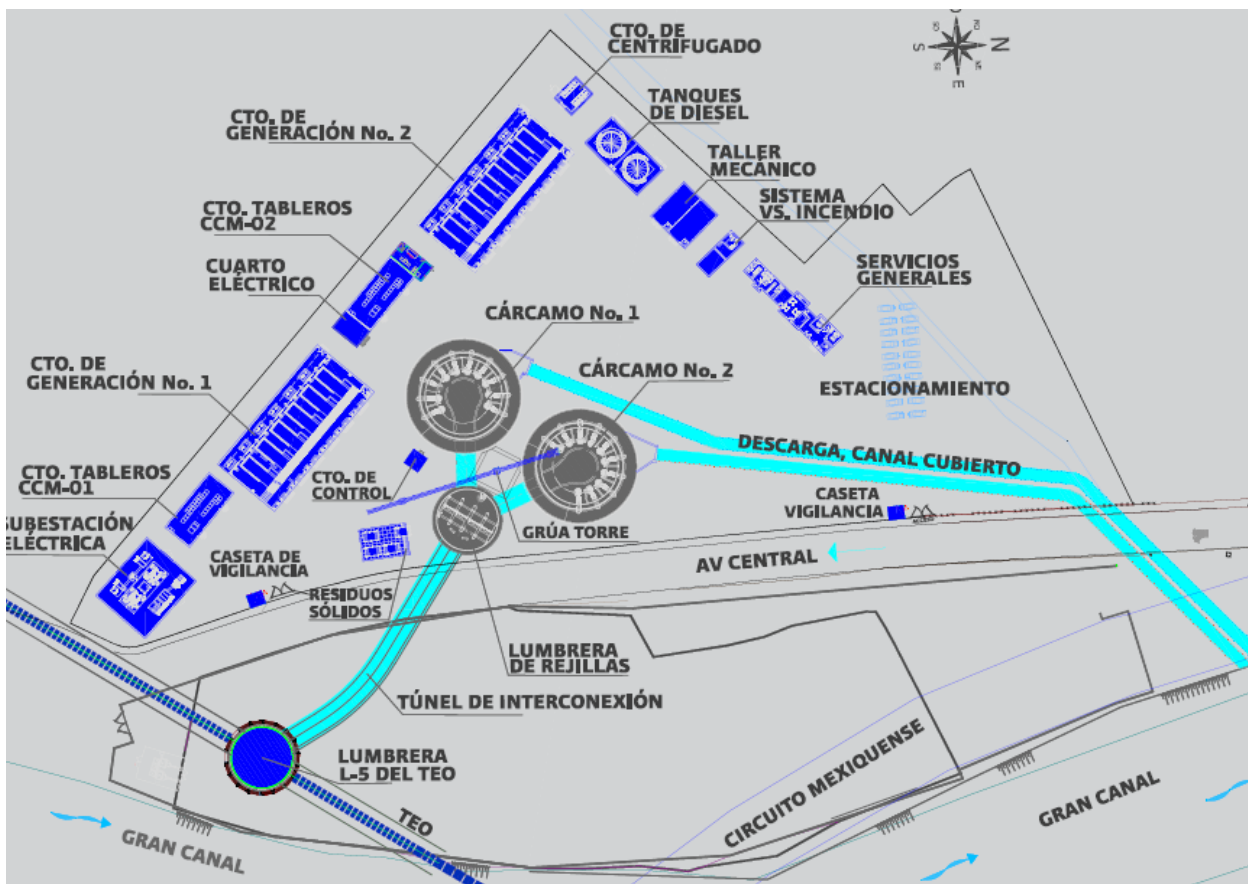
Arreglo de conjunto de la planta de bombeo El Caracol.
